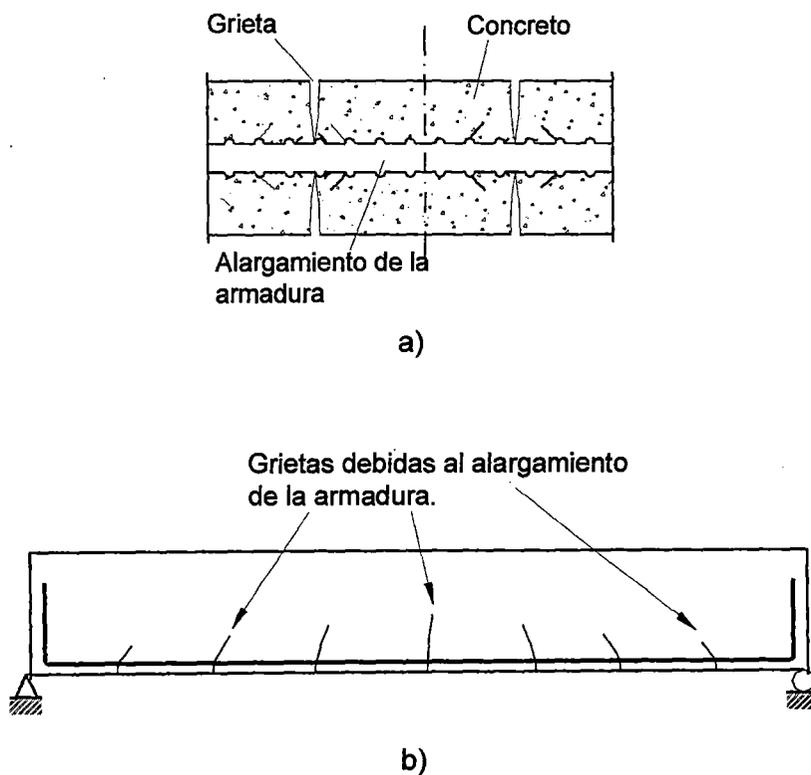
Grietas debidas al alargamiento de la armadura
